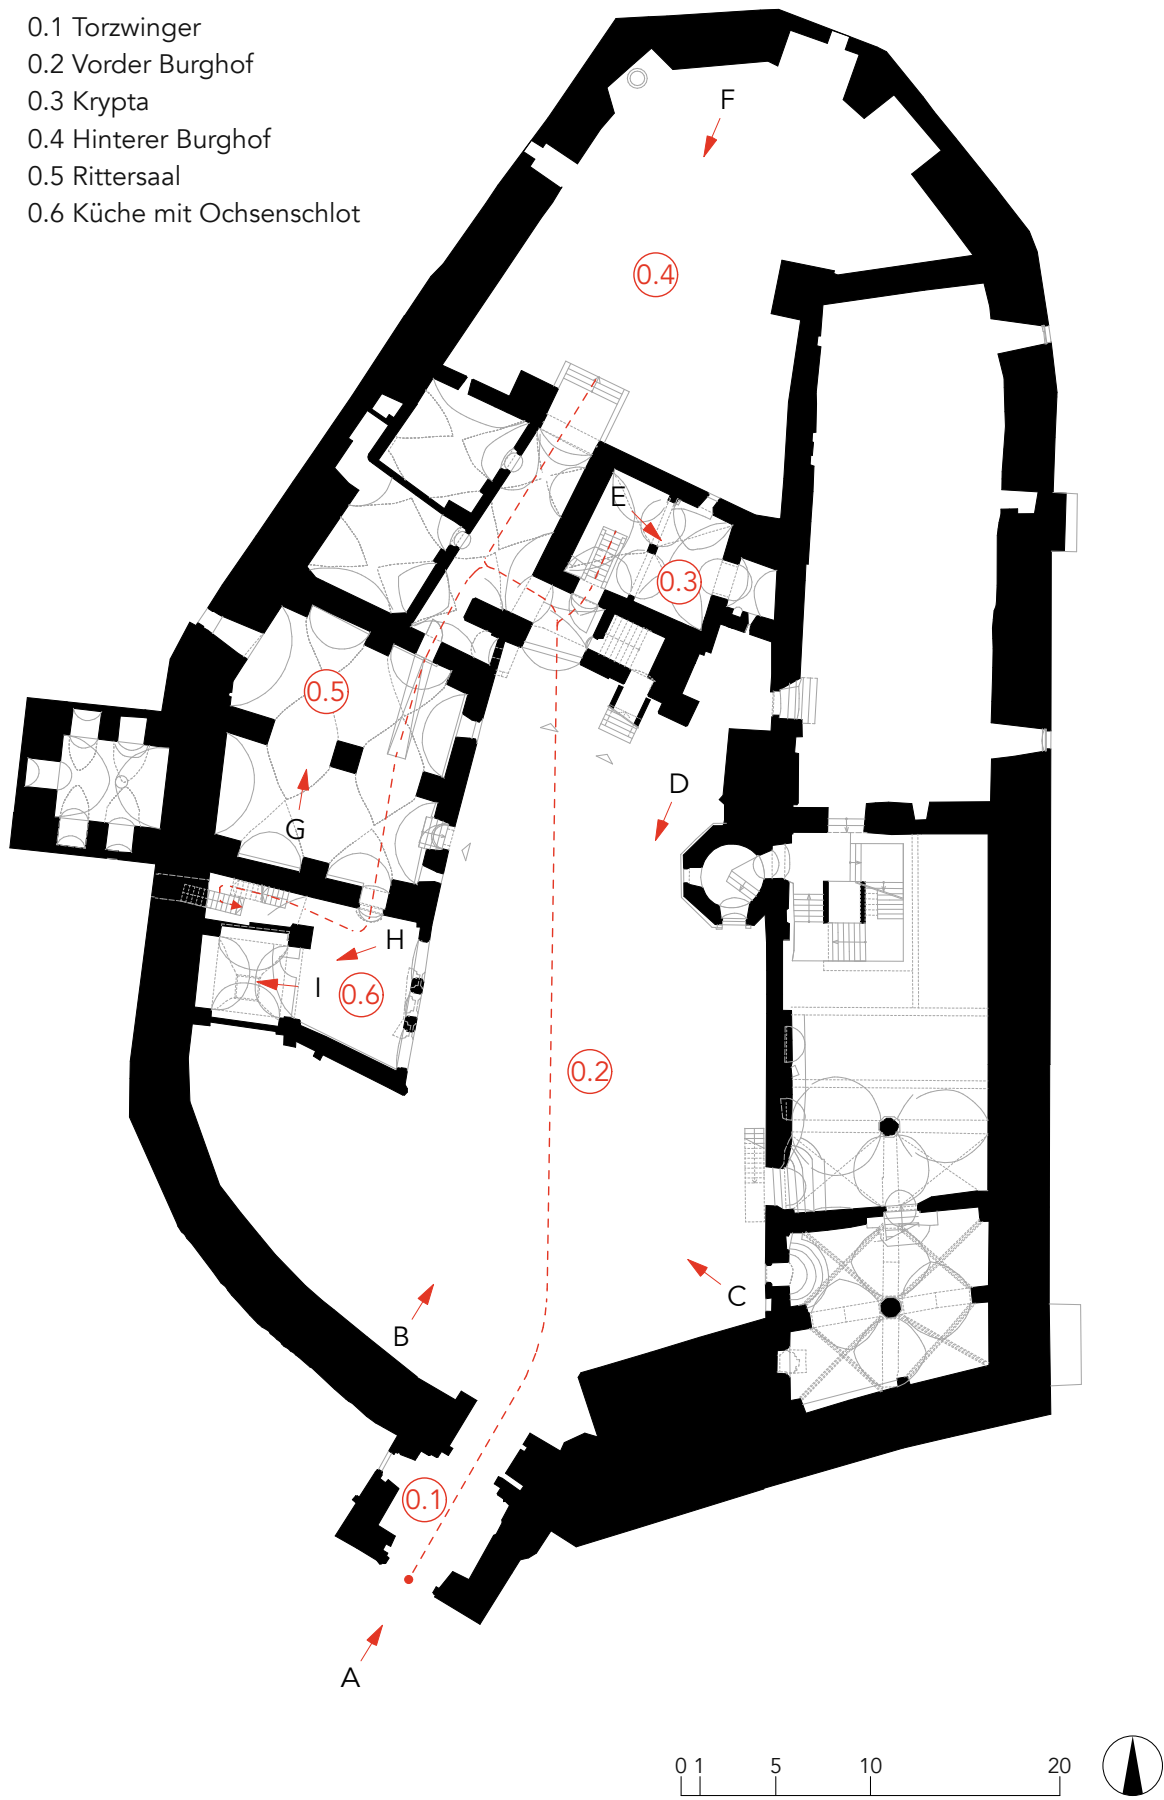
Grundriss Erdgeschoss der Kernburg, gezeichnet von Verfasser nach Plan von Architekten BDA Claus + Forster
